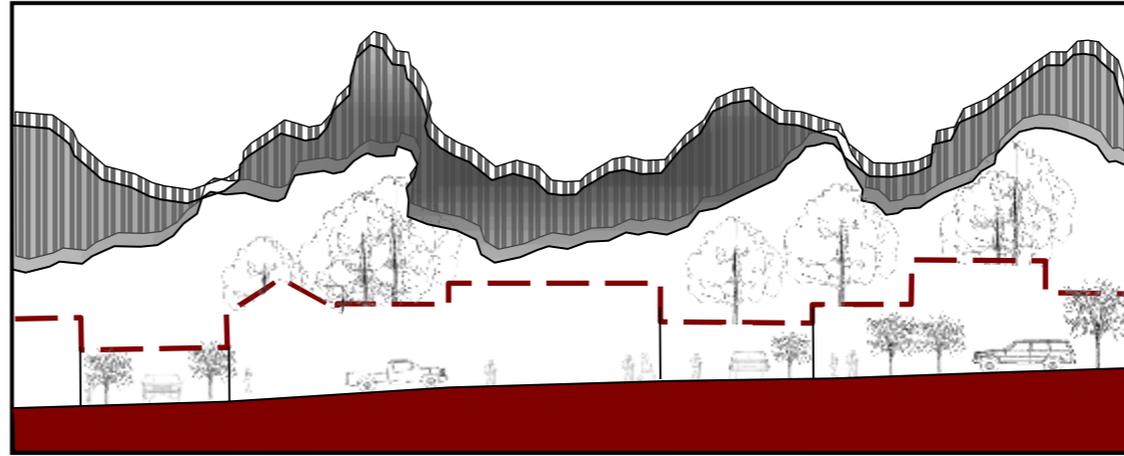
Tipo de vivienda localizada en la Libertad 1 Alameda A1-3
